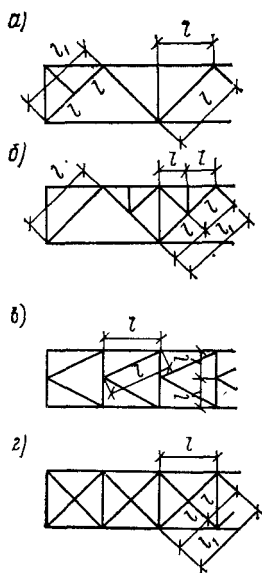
Схема ферм для определения расчетных длин элементов
